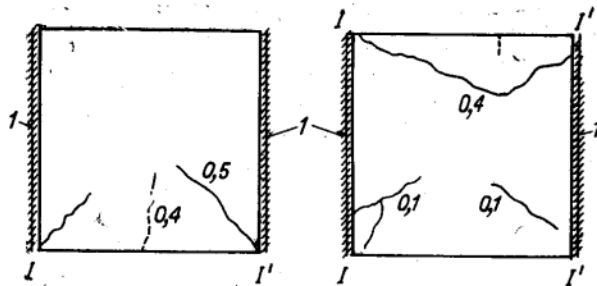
Характер расположения трещин в плитах А от монтажной нагрузки
